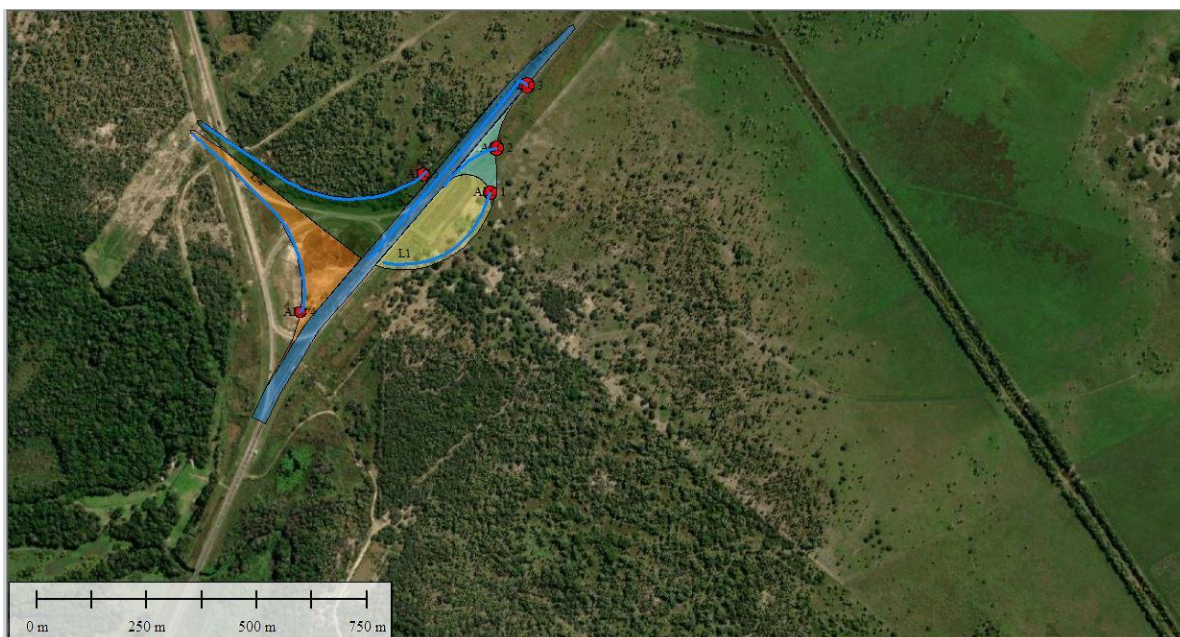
Ubicación de las alcantarillas - Fuente: elaboración propia
